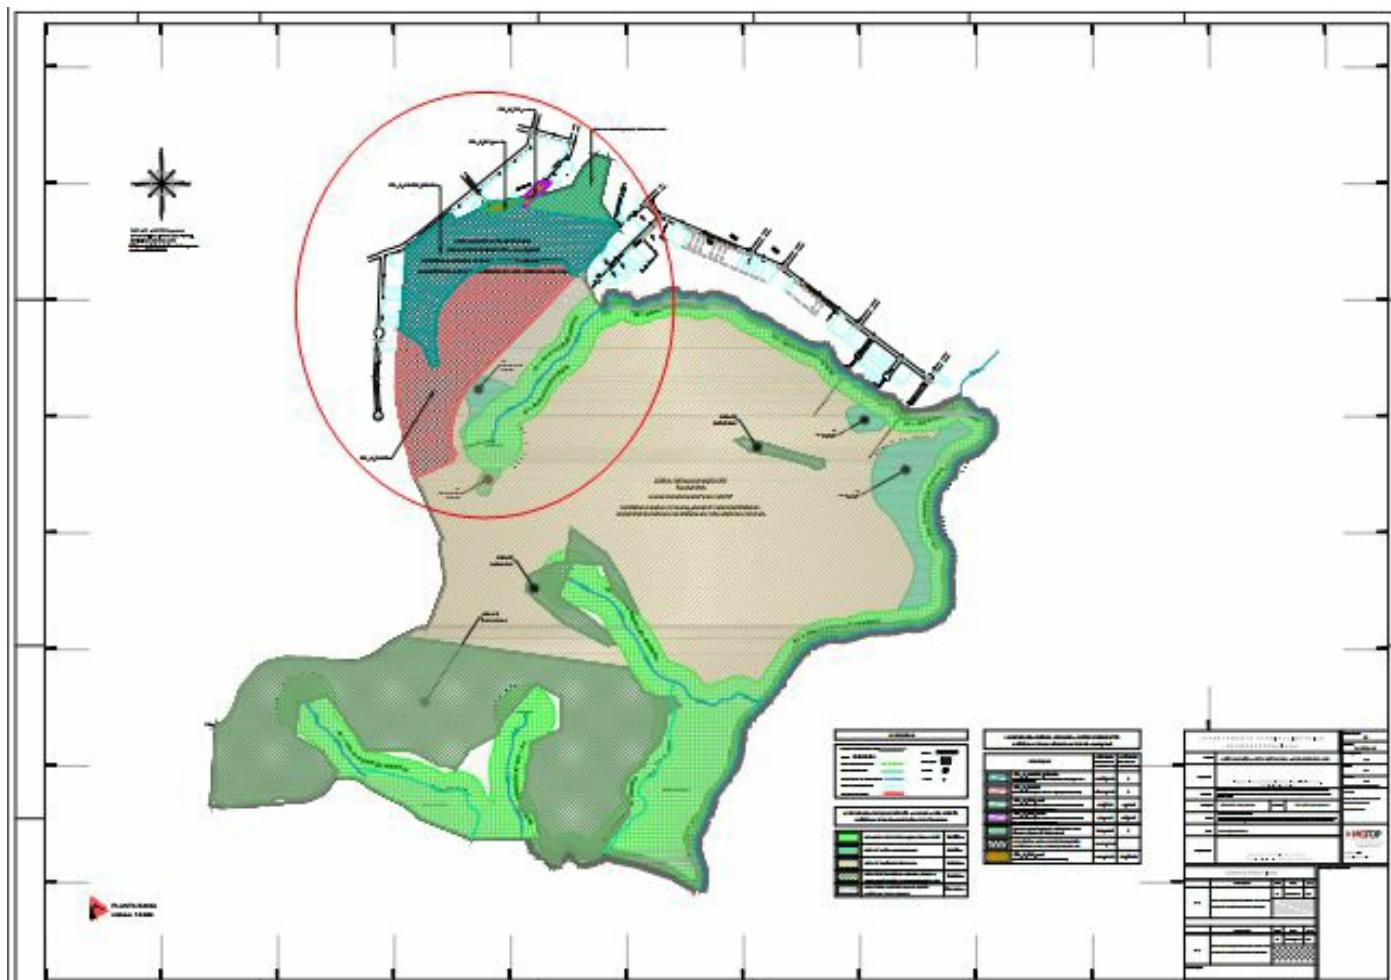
Planta da propriedade, com destaque para a área do loteamento, dentro do círculo vermelho. (Imagem obtida dos autos).
